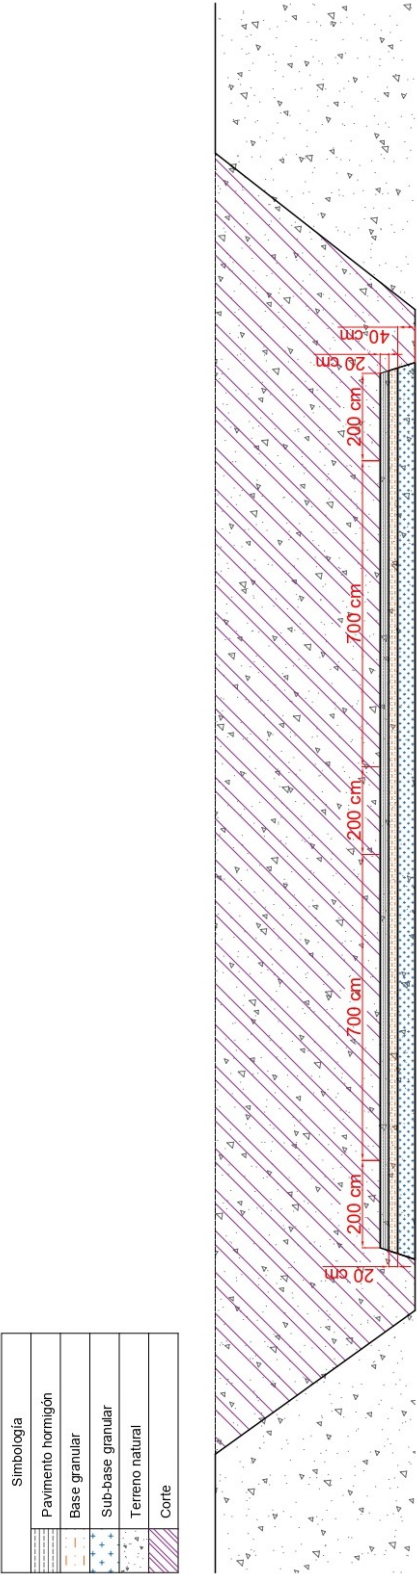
Diagrama transversal carretera para la sección de corte. Fuente: Elaboración propia.
